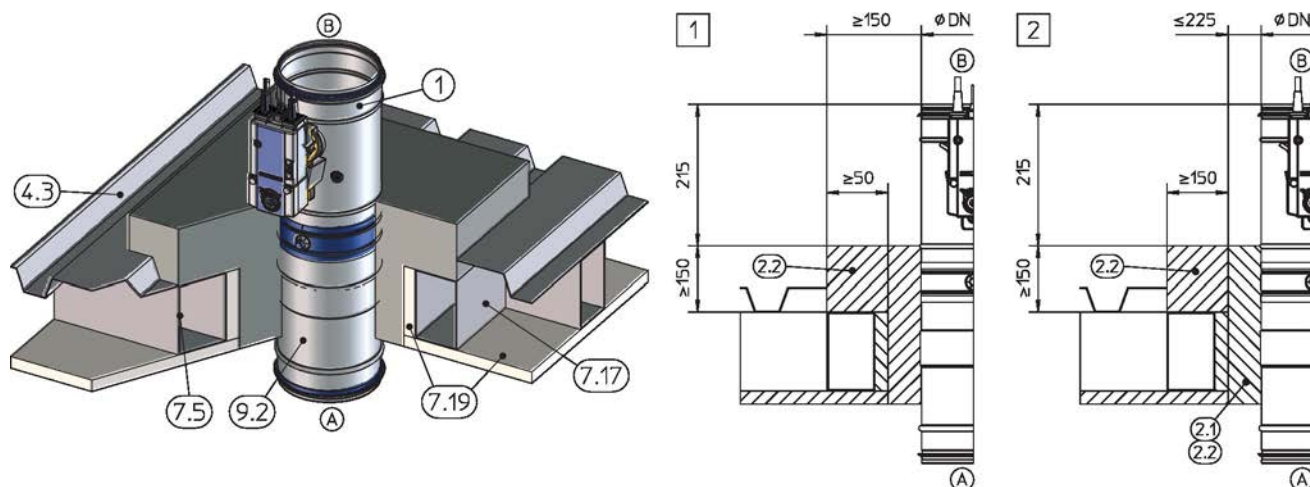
Installazione a base di malta in soffitti pieni a soletta in collegamento con soffitti pieni di legno, raffigurata verticale (applicabile anche per una disposizione sospesa)
